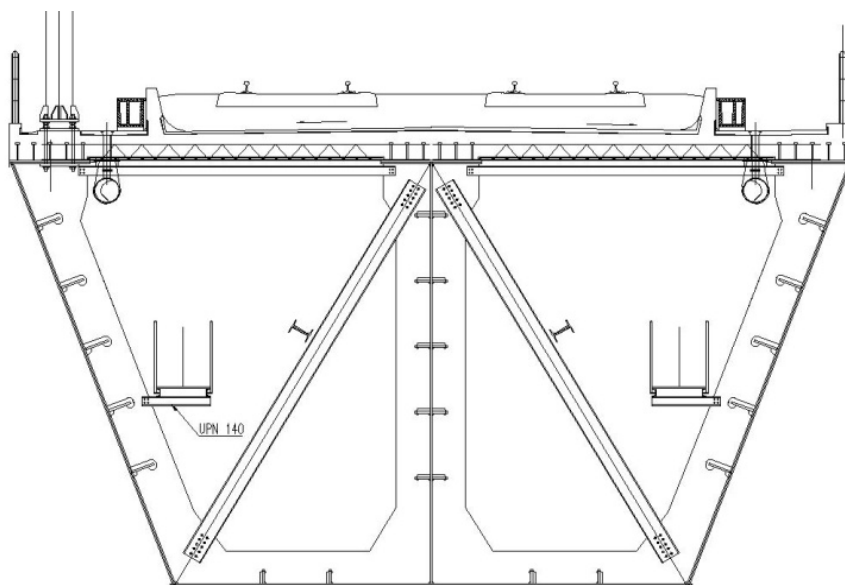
Sezione trasversale dell'impalcato ferroviario e stradale in corrispondenza della pila
